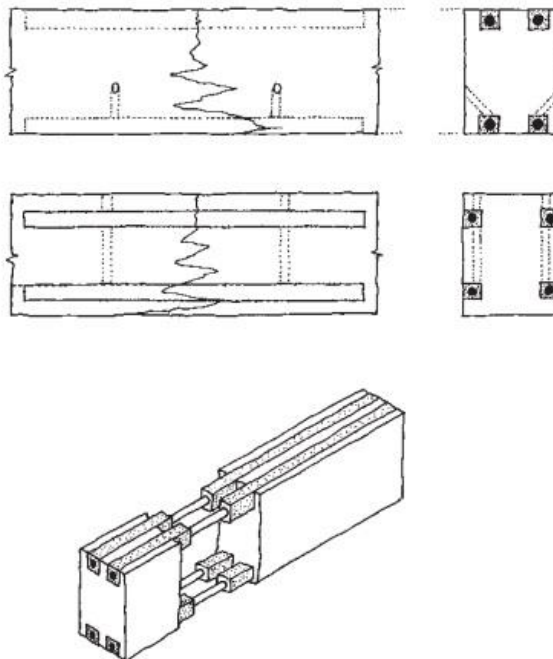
Consolidación mediante barras de refuerzo. Arriaga Martitegui, Francisco. *Intervención en estructuras de madera.
